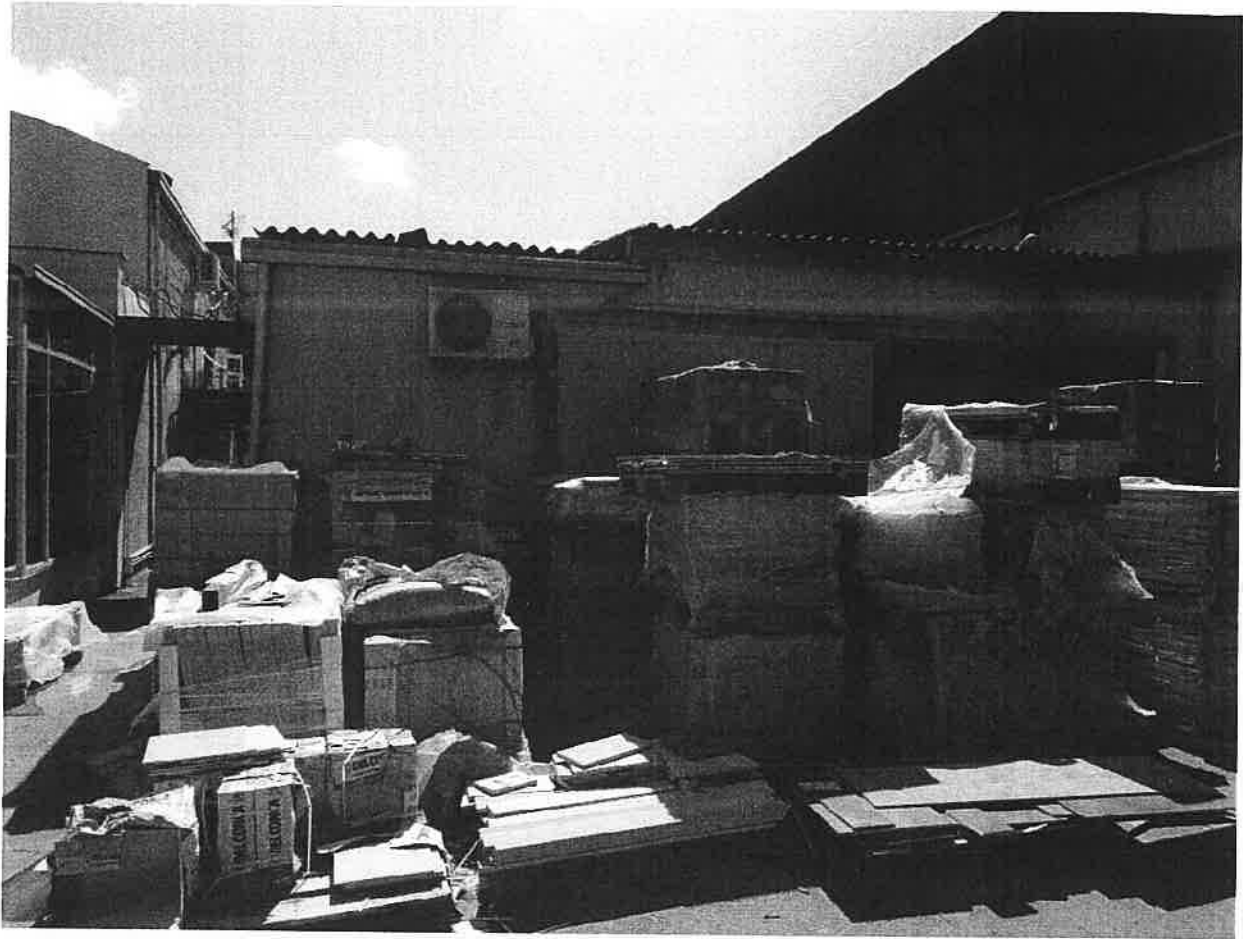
Prospetto anteriore del locale adibito ad esposizione
